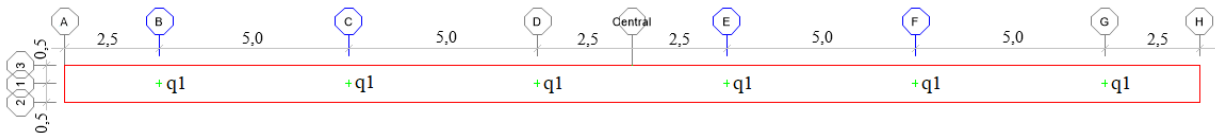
Croqui da estrutura em planta com os pontos de cargas verticais (Fonte: Autor, 2018)
